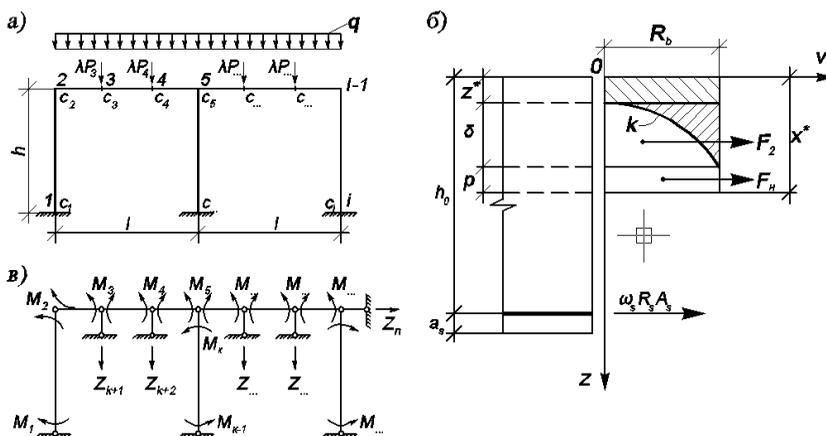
Заданная (а), основная (в) системы рамы и расчетная схема поперечного сечения железобетонного элемента (б)
